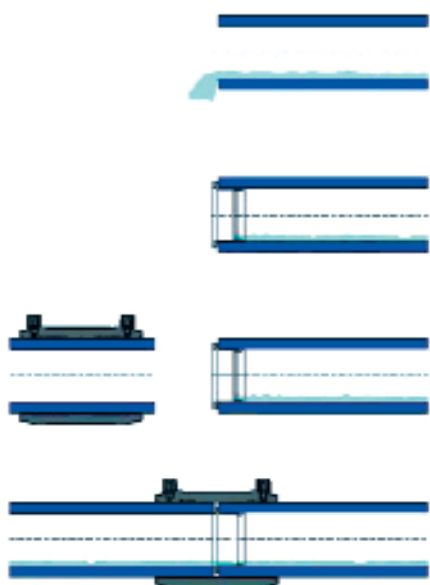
Временное перекрытие зоны сварки при помощи мембраны, растворимой в воде
